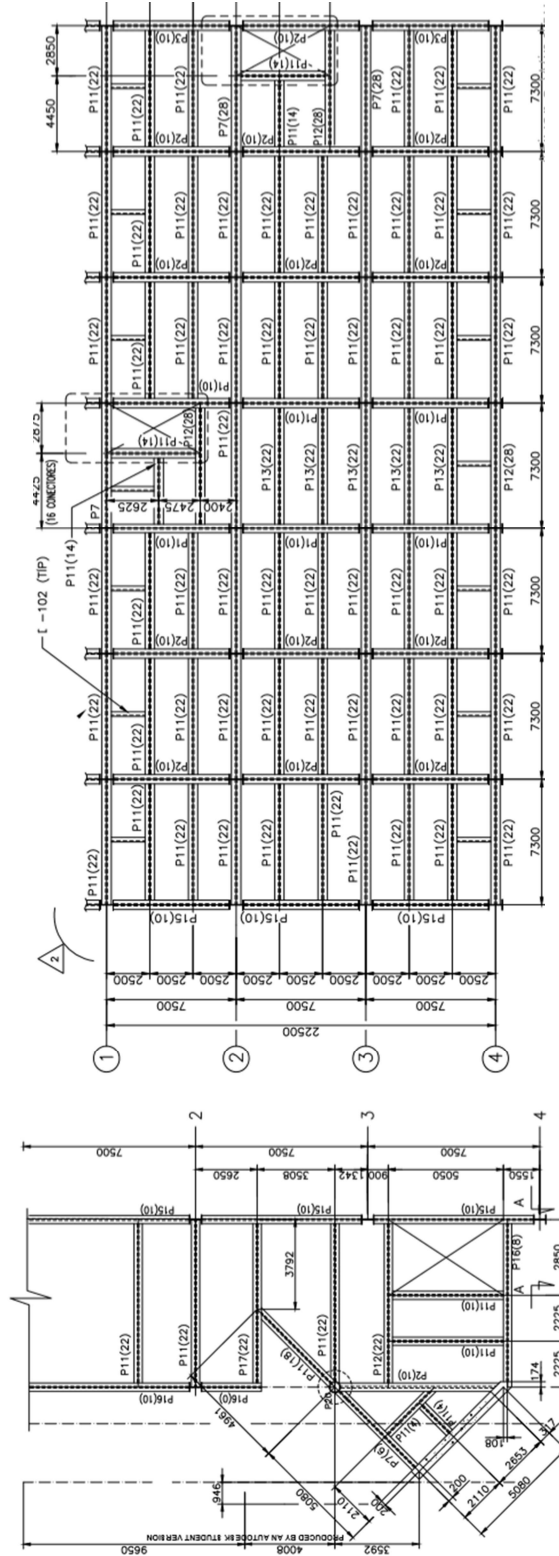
Forma das vigas para os pavimentos 1, 2 e 3 (Fonte: Projemax Projetos Industriais)
